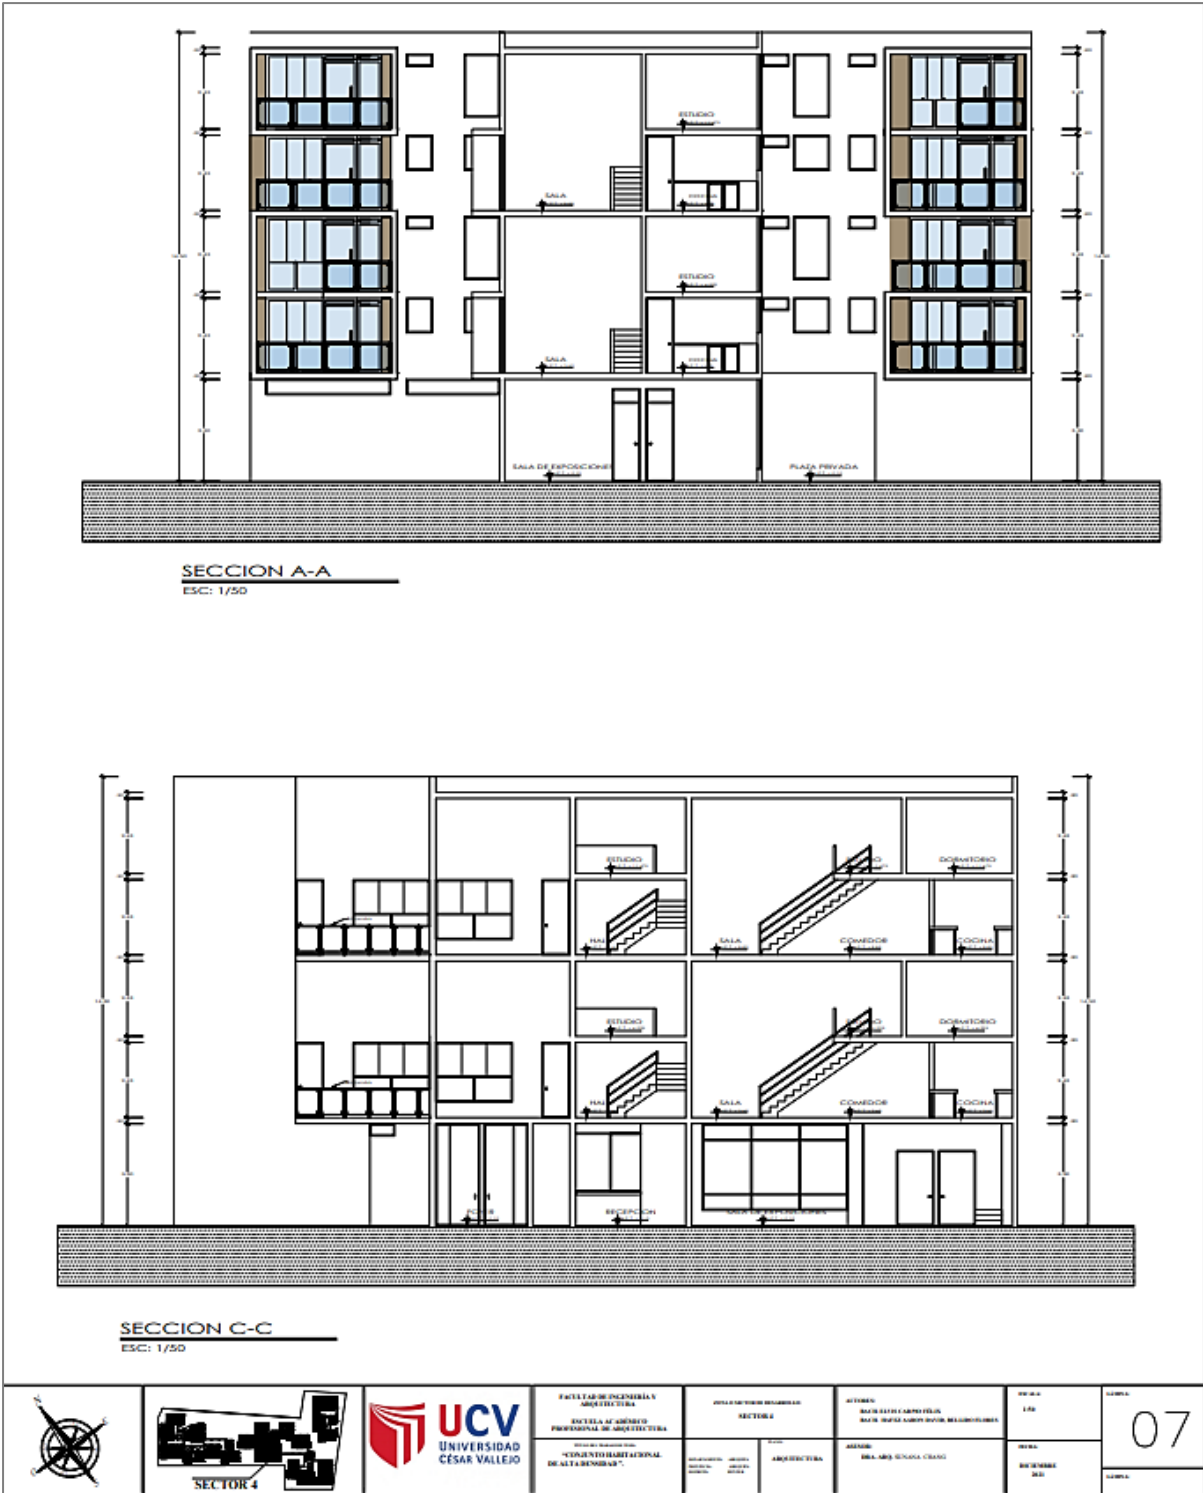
Planos de Arquitectura – 07 - Bloque 4 – Secciones A y C
